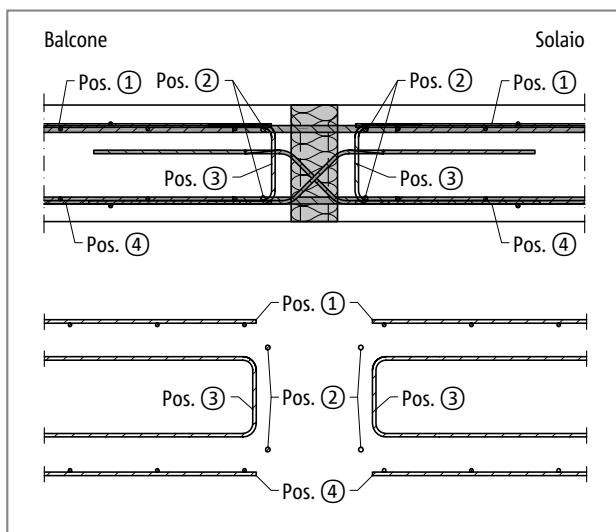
Schöck Isokorb® tipo D, armatura in opera
